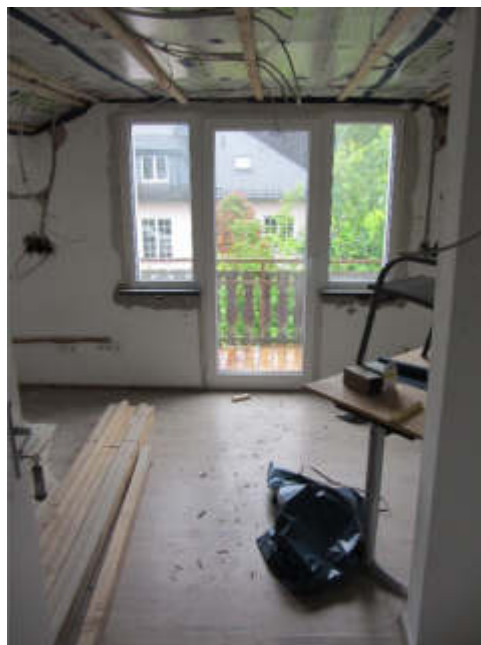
Obergeschoss: Zimmer Sanierungsfläche
